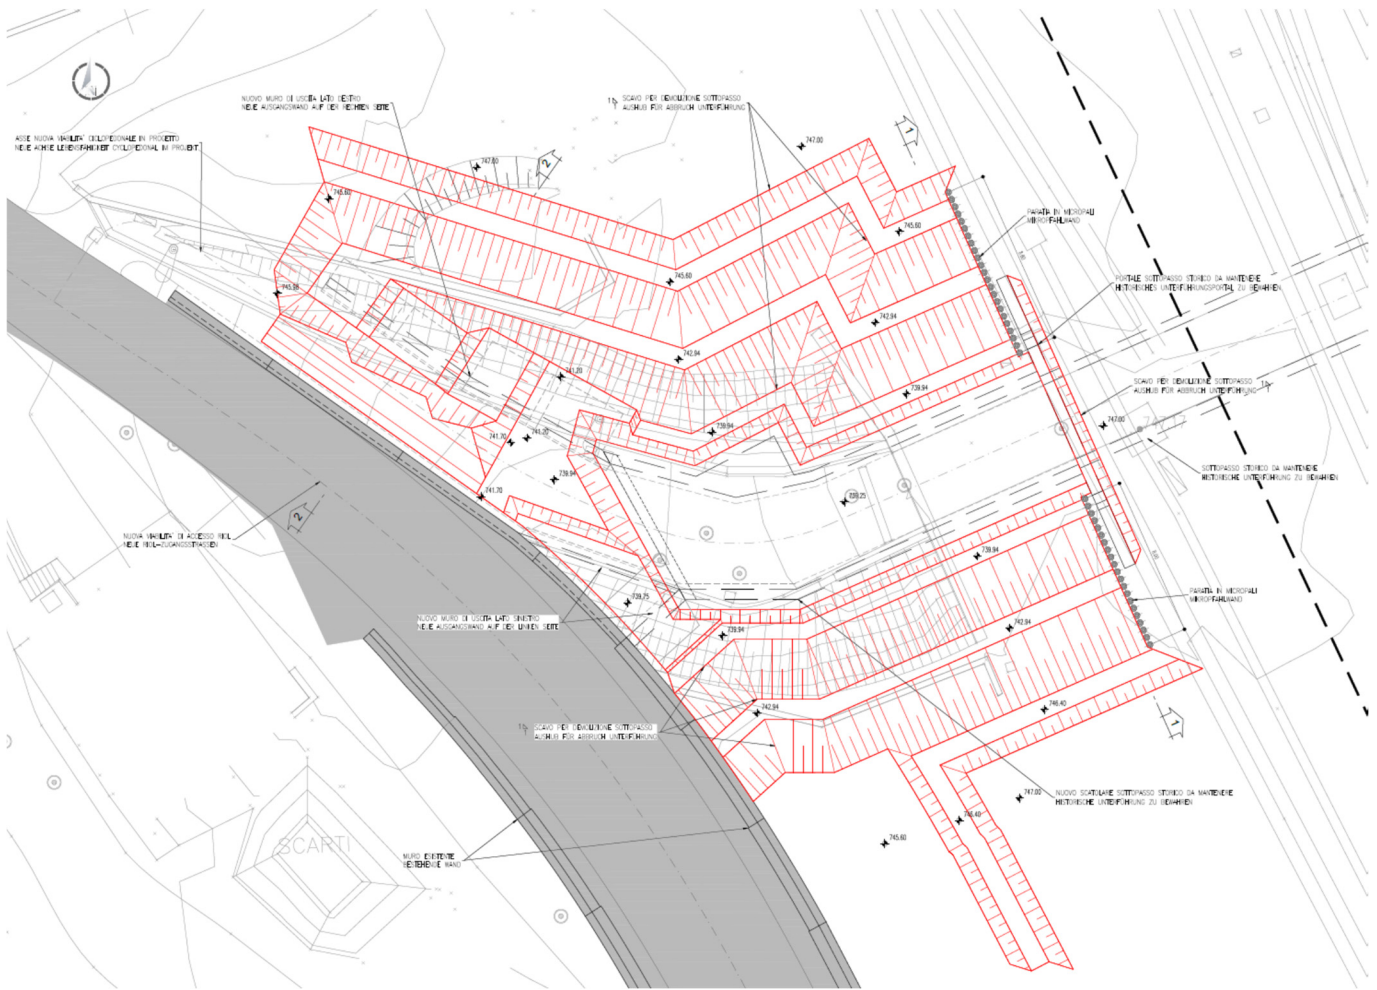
Grundriss mit Lage der Aushubflächen
